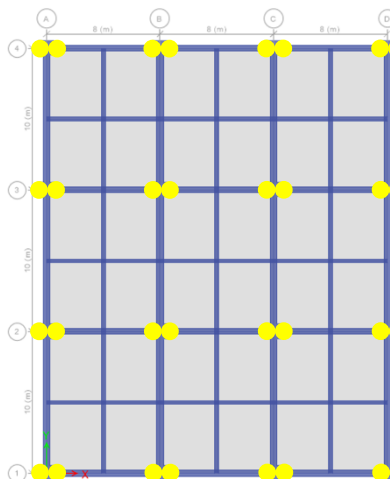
Configuración de los aisladores en la planta del edificio de 40 niveles
